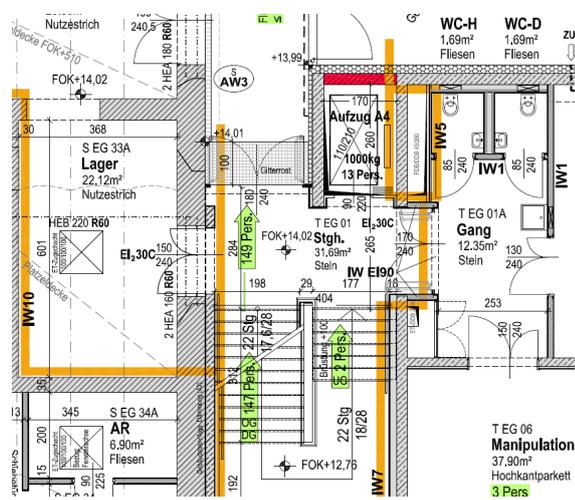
Planausschnitt Bestandsplan TEG01_2
